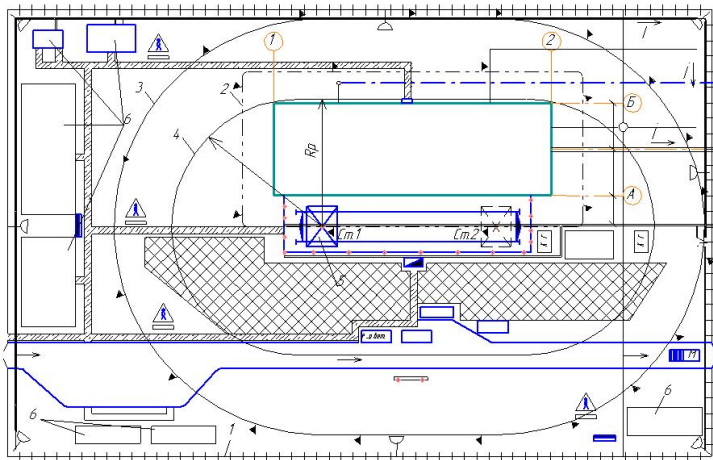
Границы зон при работе башенного крана: 1 – ограждение строительной площадки; 2 – граница опасной зоны вблизи строящегося здания; 3 – граница зоны, опасной для нахождения людей во время перемещения, установки и закрепления элементов и конструкций; 4 – граница зоны обслуживания краном; 5 – башенный кран; 6 – санитарно-бытовые помещения
